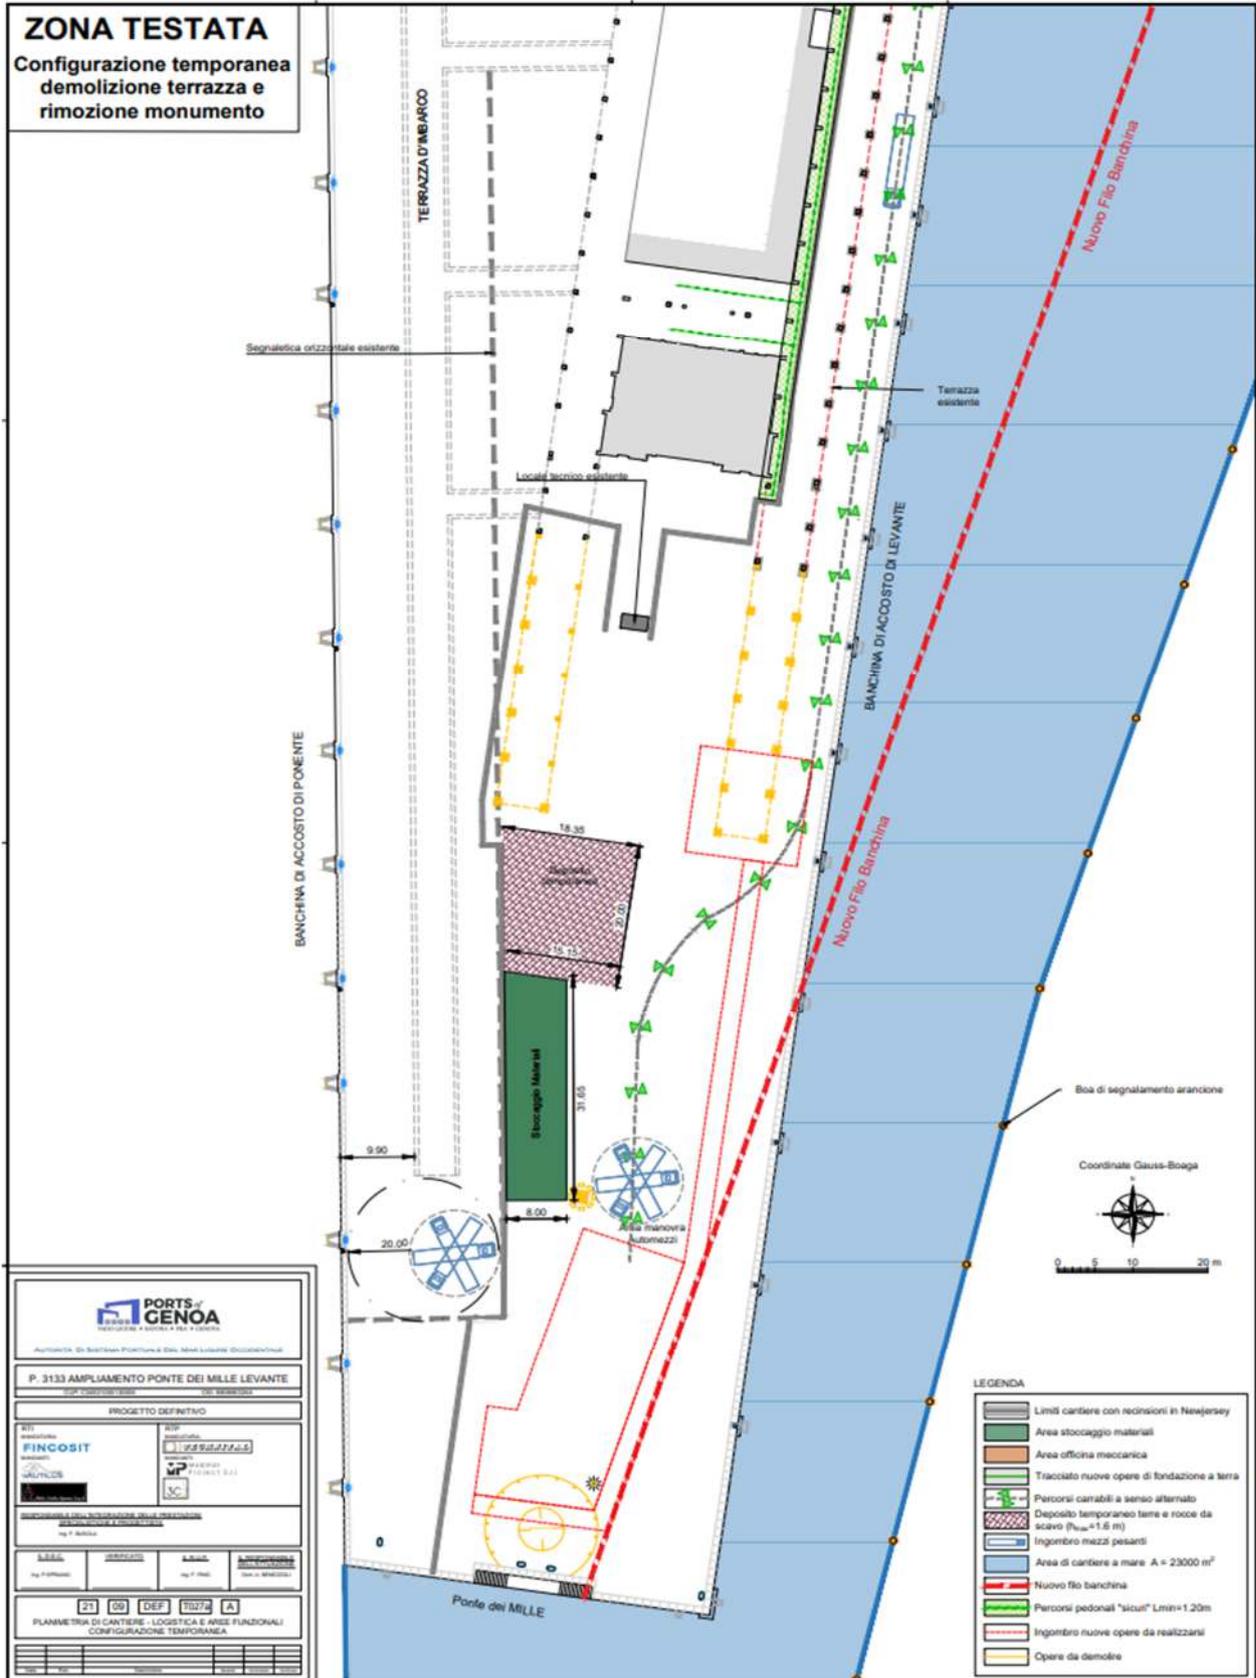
Planimetria di cantiere – Logistica e Aeree funzionali - Configurazione temporanea
